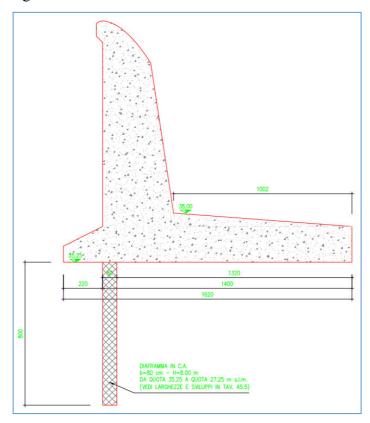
Adeguamento manufatto di regolazione - Sezione tipo con taglione in fondazione
